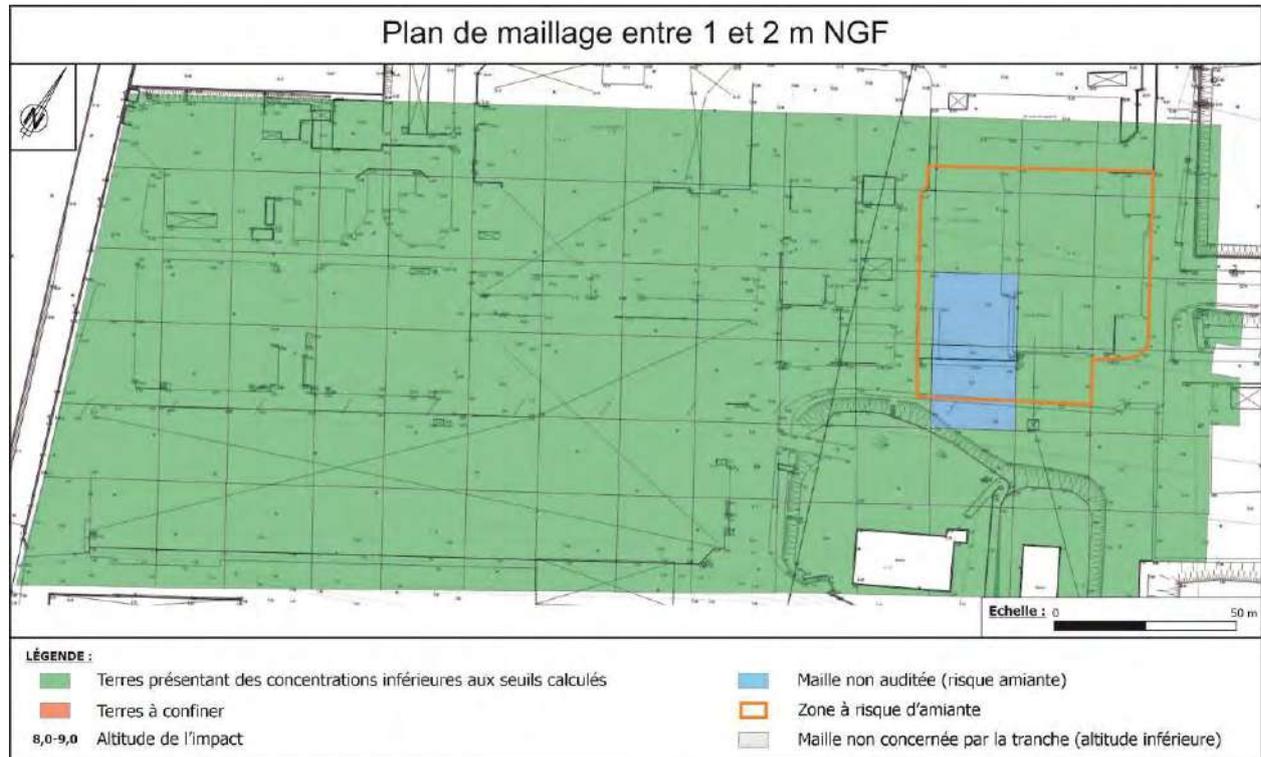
Plan de maillage entre 1 et 2 m NGF
